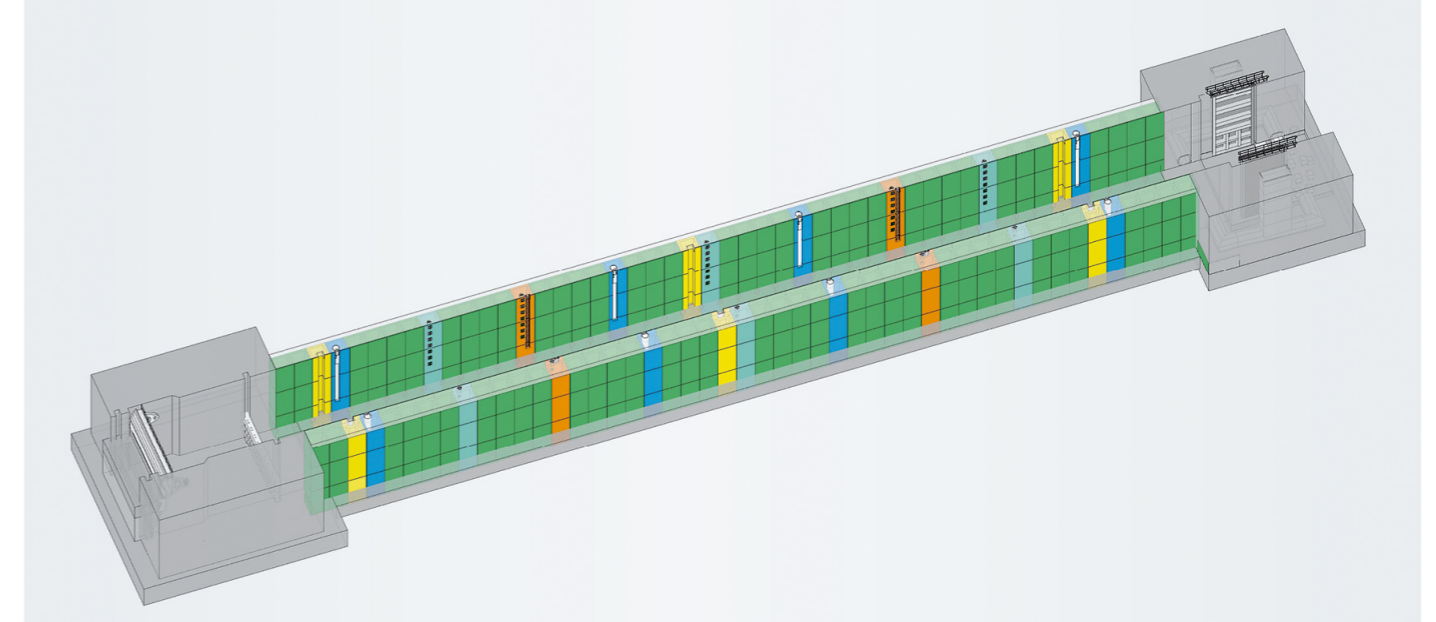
Mögliche Fertigteilrasterung einer Schleusenammer
